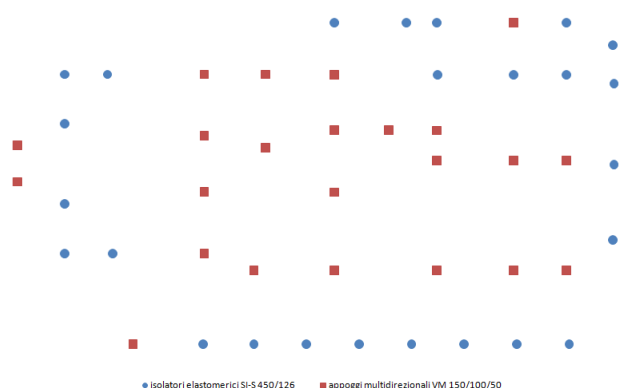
Disposizione in pianta dei dispositivi elastomerici e delle slitte
